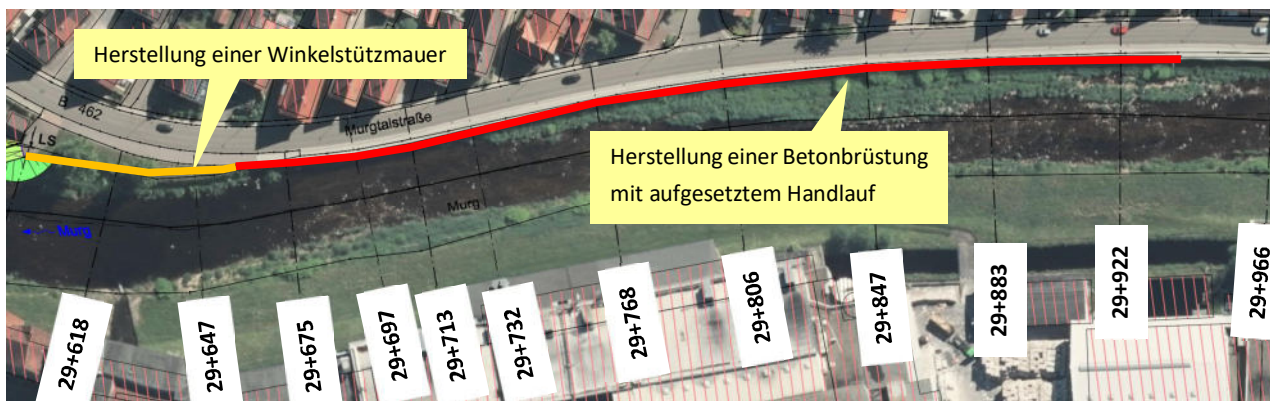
Lageplan Maßnahmen M4, Bereich B 462 oberhalb der Bebauung Murgtalstr. 2 - 16
